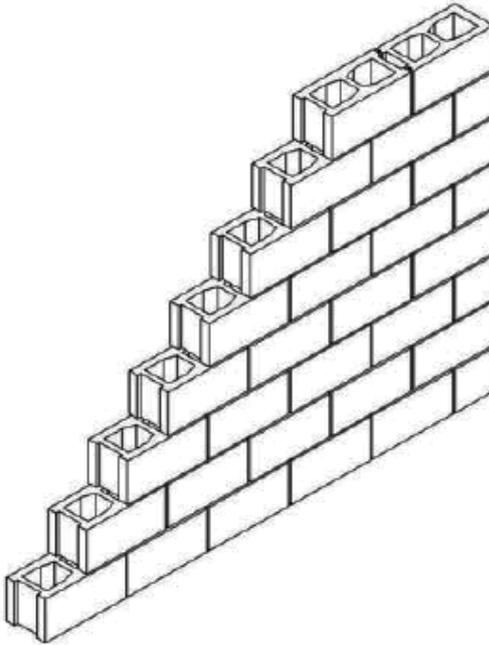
Muro aparejado de Bloques de Hormigón Hueco.
